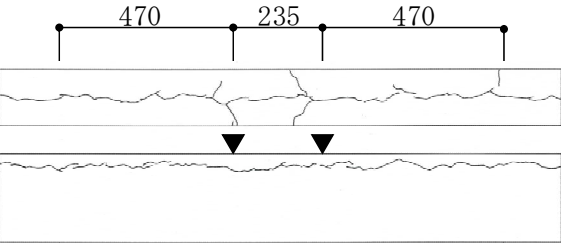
載荷前ひび割れ状況の例(No.4)
